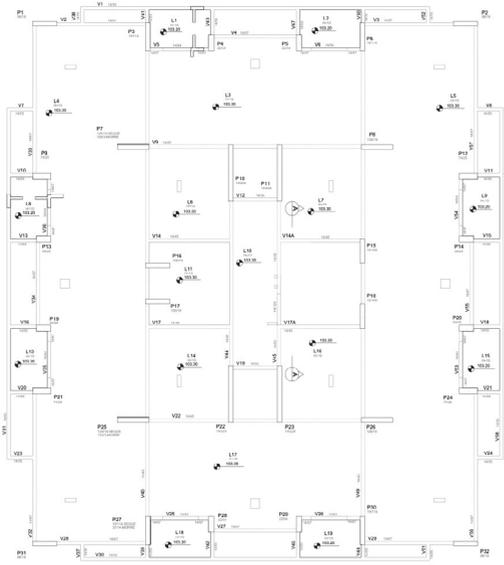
Planta de fôrma – 1º pavimento (teto do térreo).
